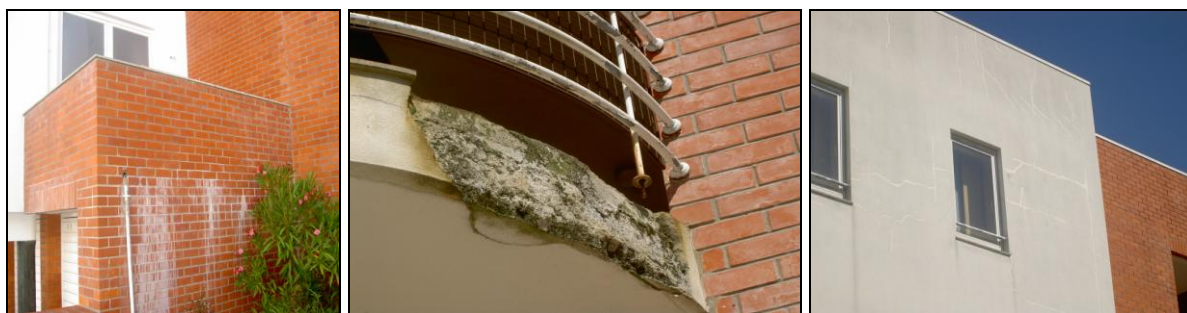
Manchas de coloração branca nos muretes das varandas. Fissuração e destaque dos patamares da escadaria. Fissuras no revestimento da fachada.
